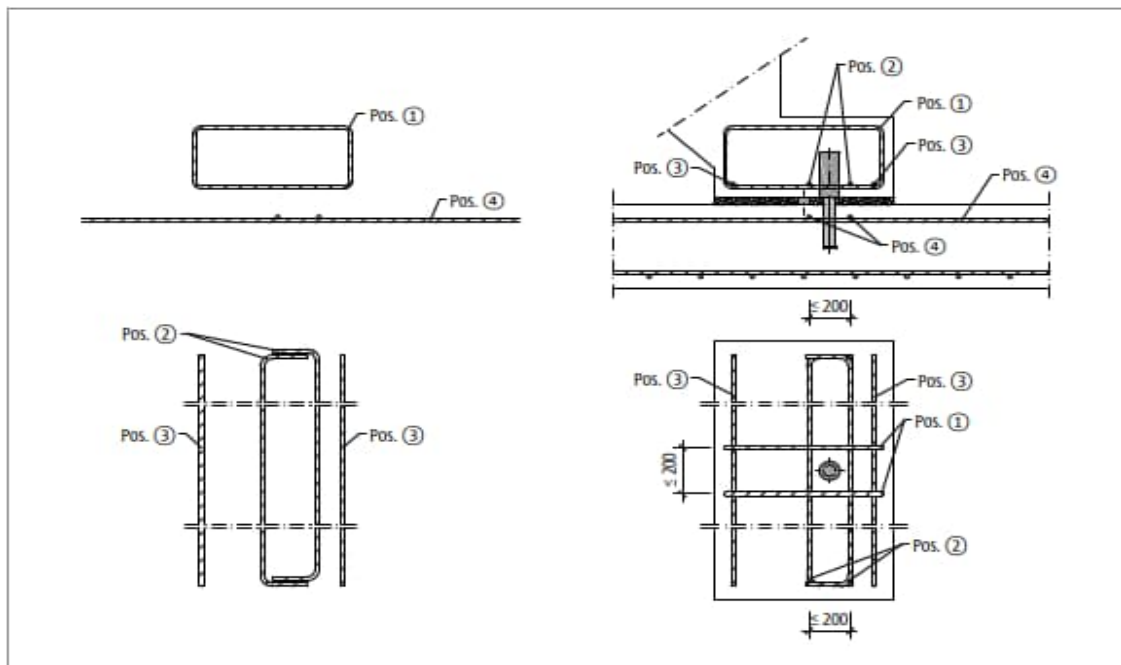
Schöck Tronsole® Typ D: Bauseitige Bewehrung
